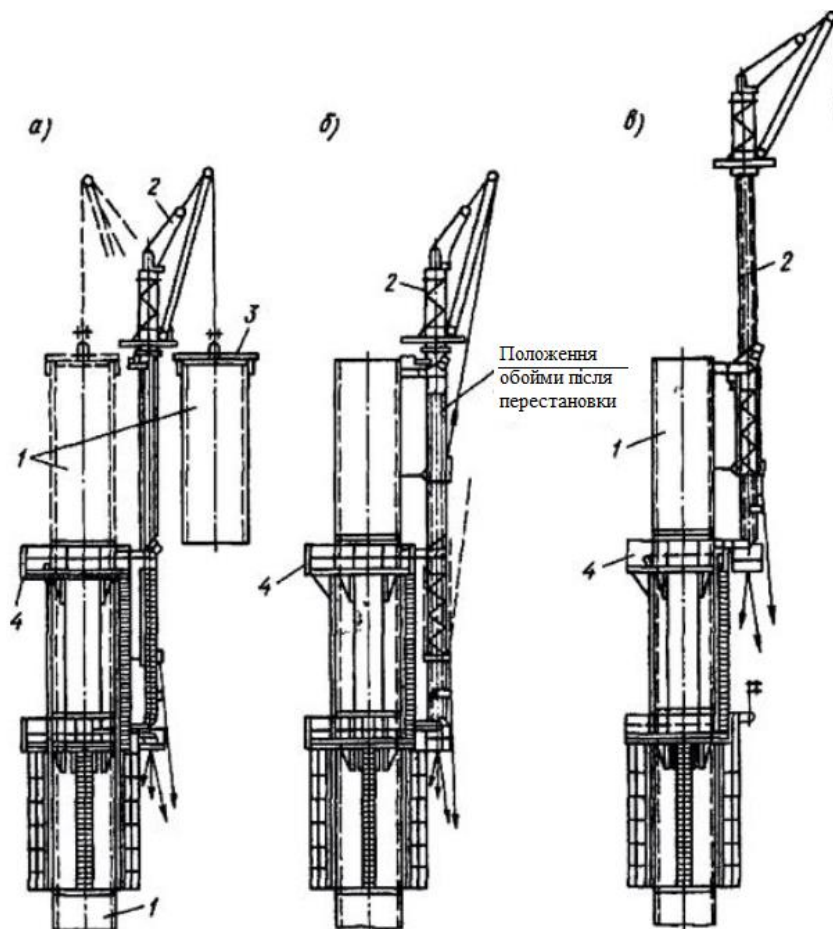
Схема монтажу сталеві димові труби само підйомним краном: а – монтаж царги; б – перестановка обійми крана; в – перестановка ствола крана; 1 – царга труби; 2 – само підйомний кран; 3 – траверса; 4 – кільцеве риштування
